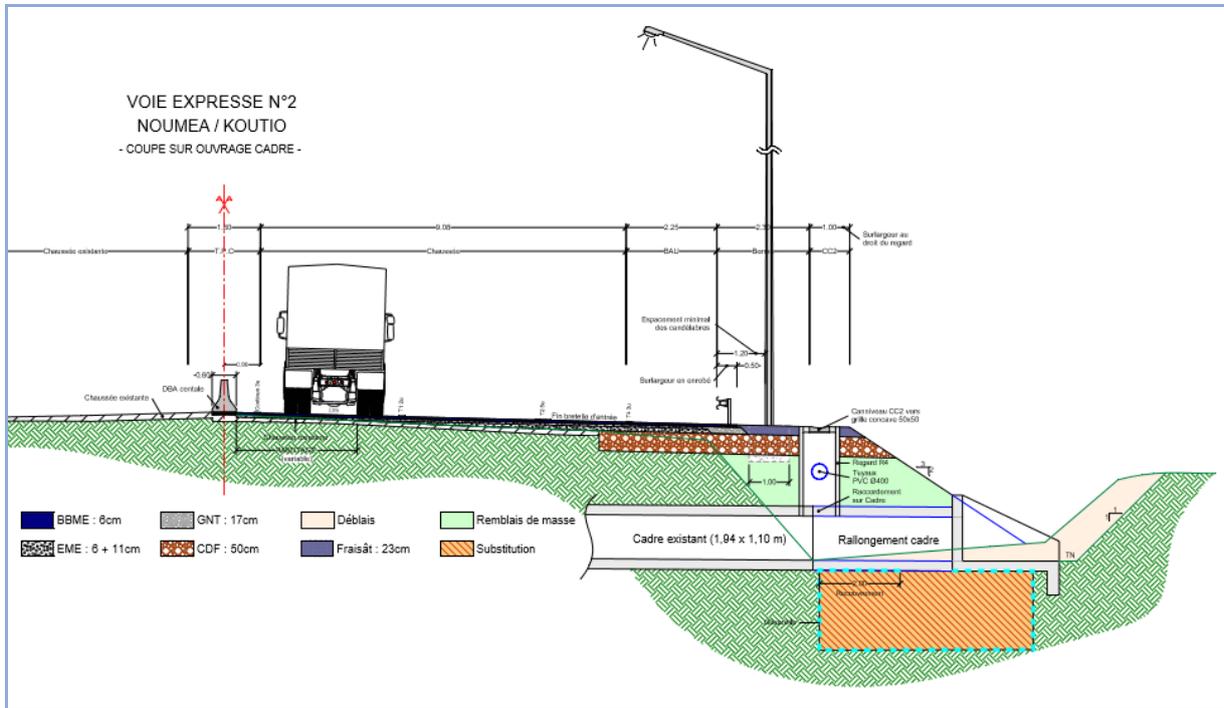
Travaux sur l'ouvrage cadre (source : DEPS - plan DCE n°2.06 de février 2016)
